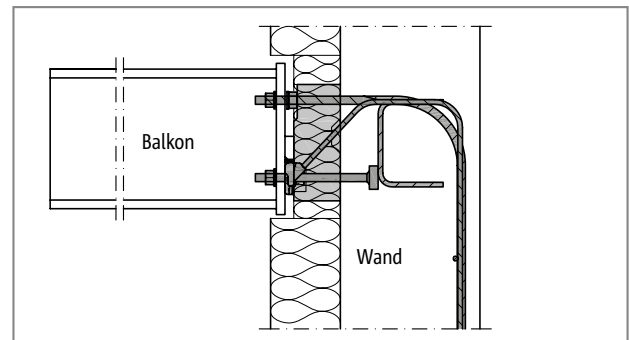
Schöck Isokorf® T type SK: aansluiting aan de vloer van gewapend beton
